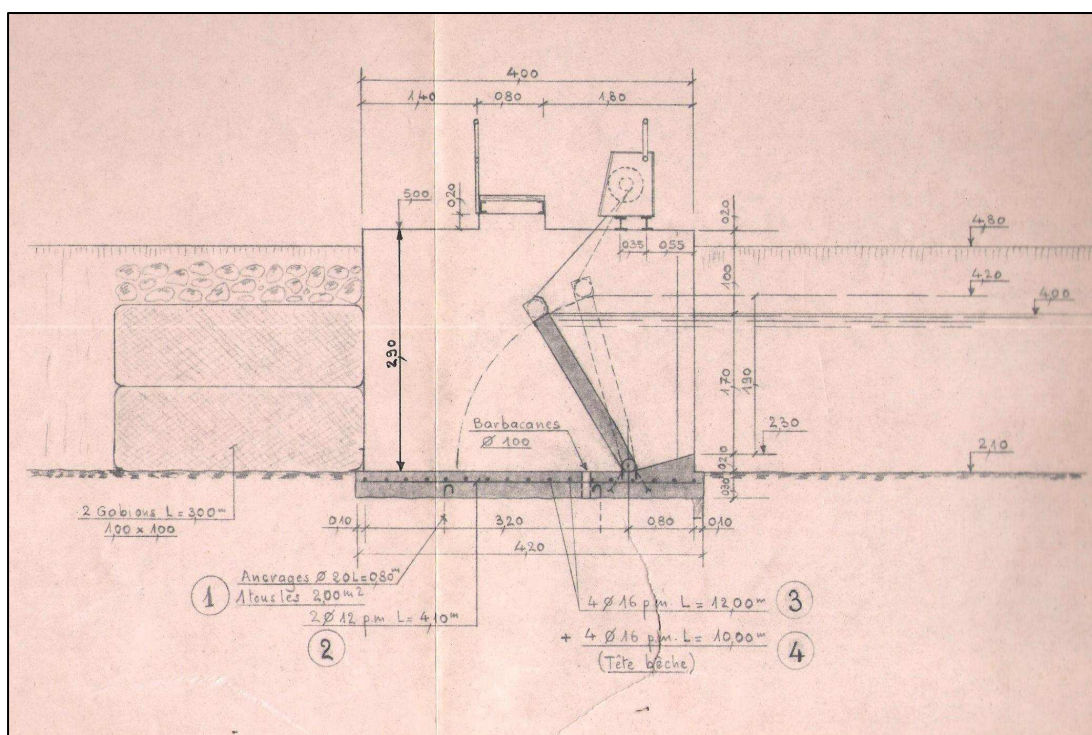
Plan en coupe de l'Ecluse de la Pinsonnière
